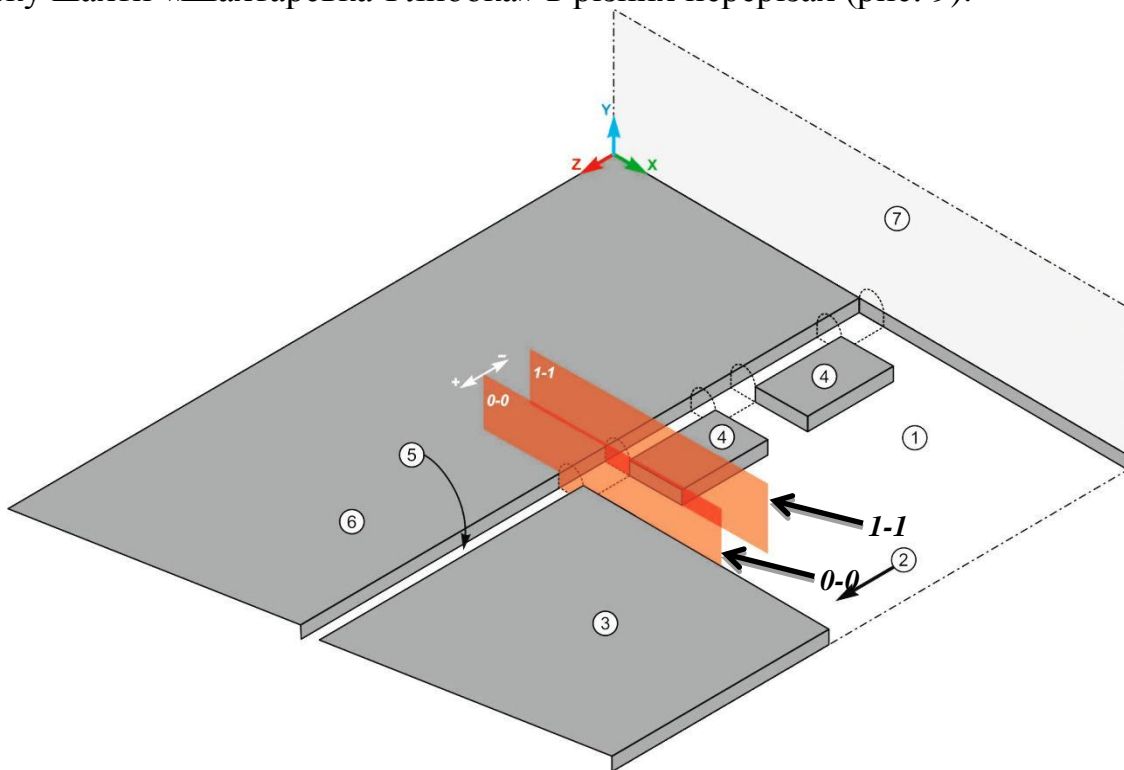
Схема розташування контрольних перерізів сполучення «лава-штрек»: 1 - вироблений простір; 2 - напрям руху лави; 3 – робоча частина вугільного пласту; 4 – запобіжні цілики; 5 - підготовча виробка; 6 - неробоча частина пласту; 7 - породи покрівлі; «0-0» і «1-1» - контрольні перерізи
